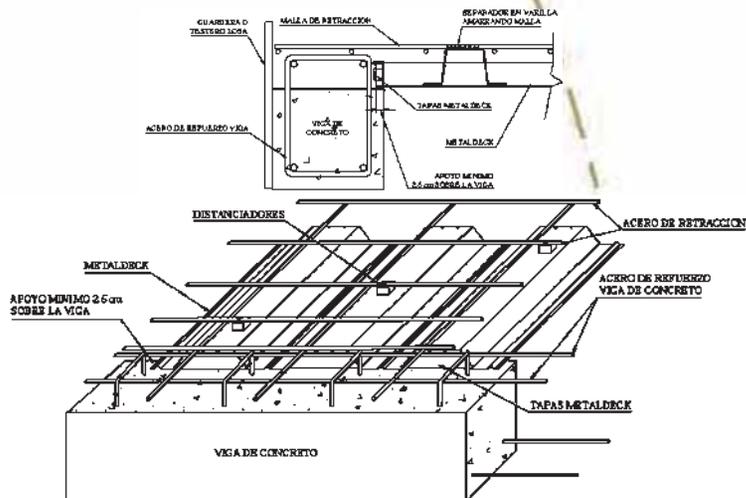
Esquema de losa acero apoyada en viga de concreto armado.
